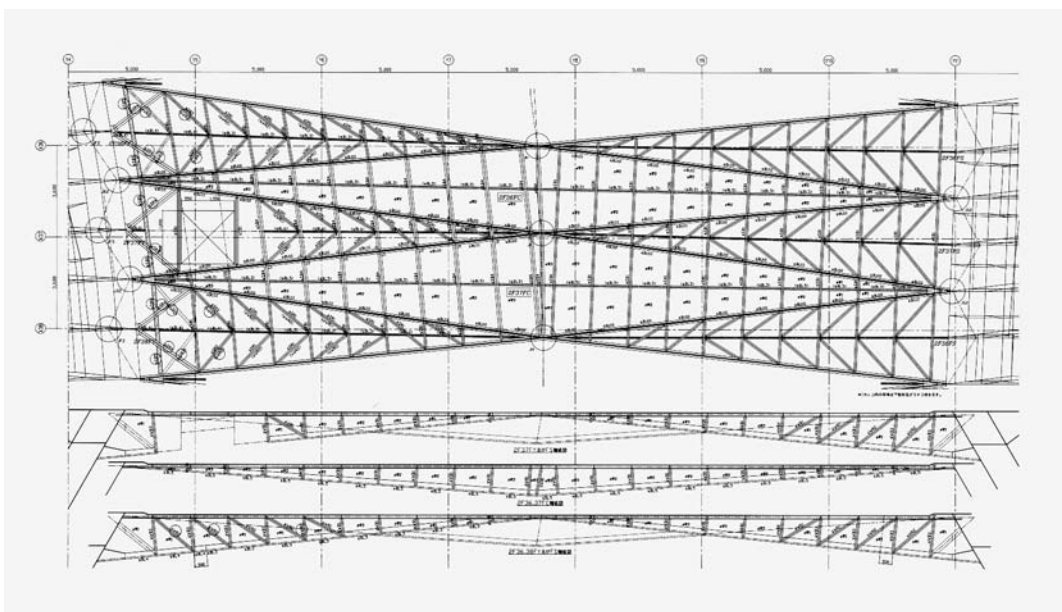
Farshid Moussavi und Alejandro Zaera-Polo/FOA, Yokohama International Port Terminal, Japan, 1994–2002. Deckenfachwerk der Dachebene, Fotografie.
